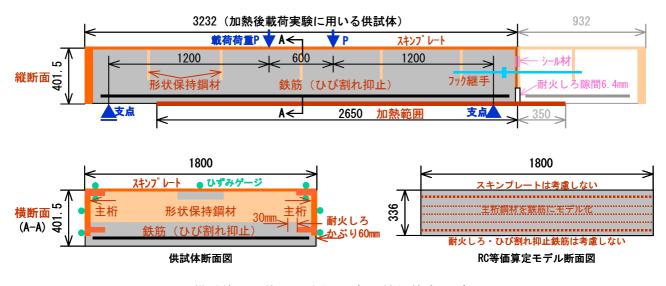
供試体の形状・寸法および RC 等価算定モデル断面図
